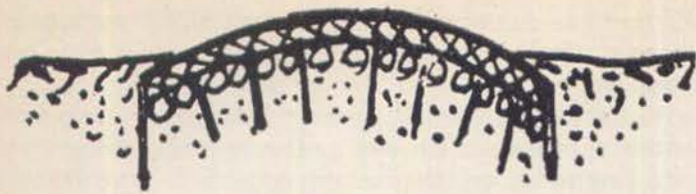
Sección de un tipo de espigón muy empleado en las plagas de Bélgica.
